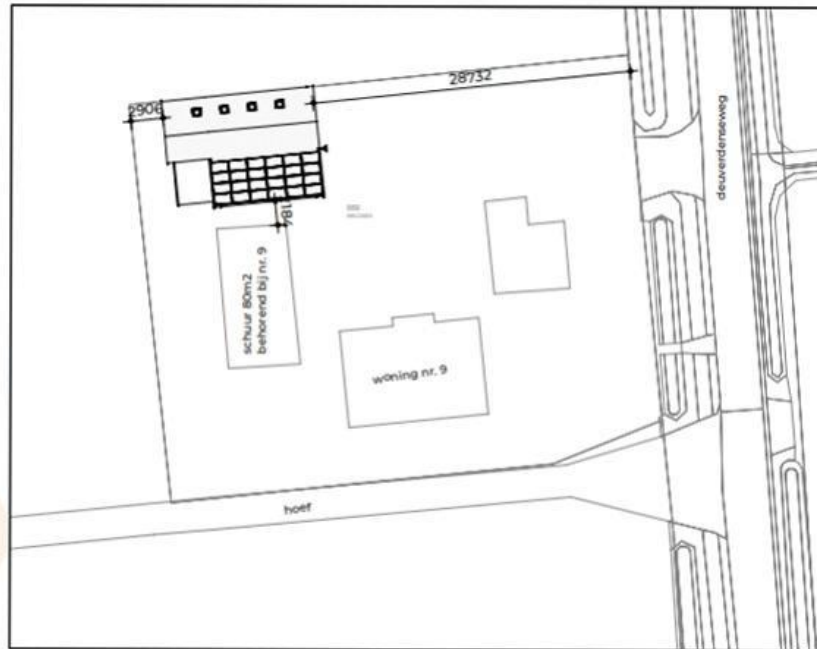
, Plan voor nieuwe woning (bron: aangeleverd door [redacted])
